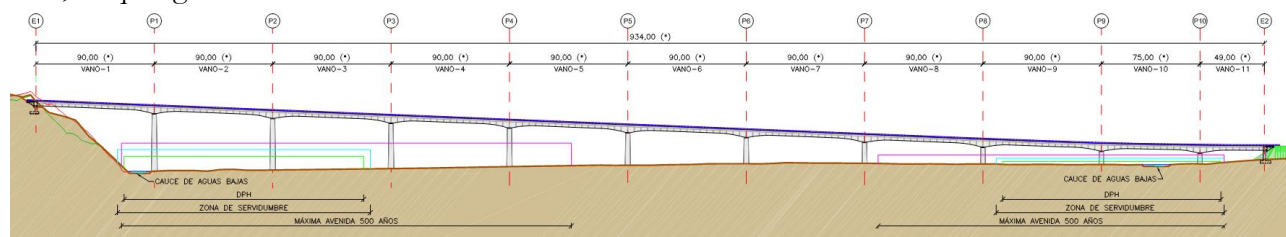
Alzado del Viaducto de Sabiñánigo ejecutado mediante cimbra autolanzable con vanos tipo de 90 m
